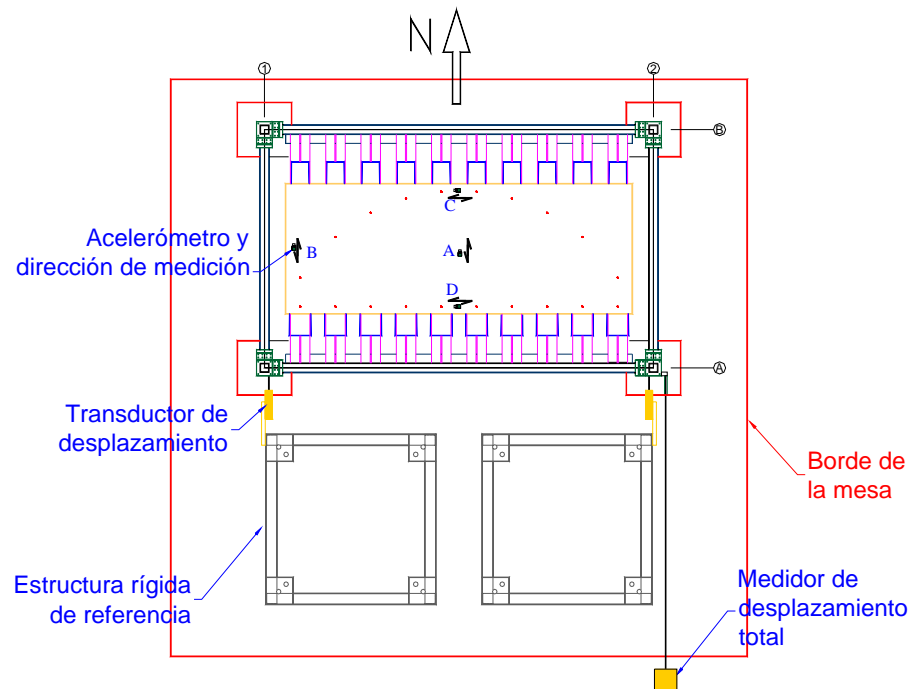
Planta del espécimen en la mesa vibradora con la instrumentación
